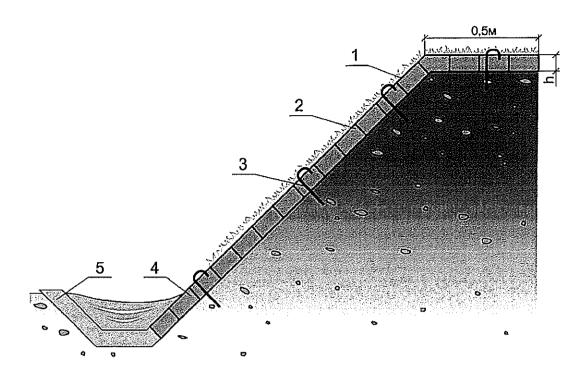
Конструкция укрепления откоса (вариант A): 1 – георешетка «OP/OP-CO/OP-CH/OP-CHO», 2 растительный грунт, 3 - анкер, 4 - бетон или щебень, 5 - водоотводной лоток
